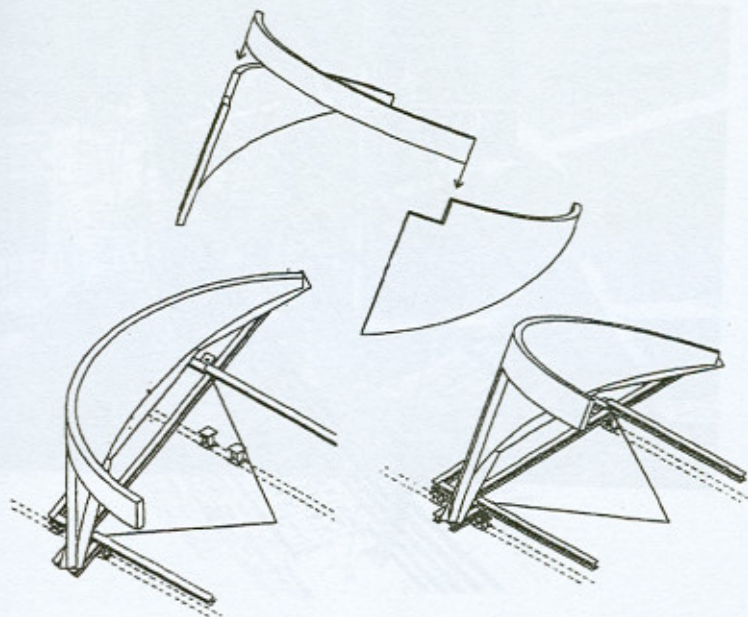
1ª Opción prefabricada. Despiece en 3 partes.
